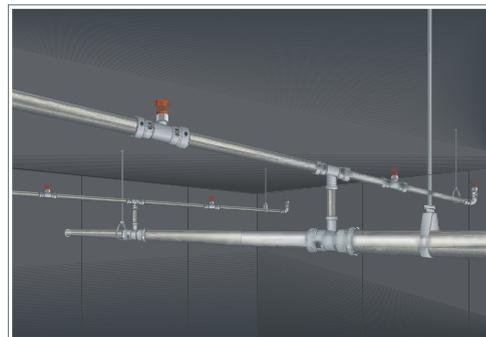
Sprinkleranlage mit Viega Megapress und verzinktem Stahlrohr
